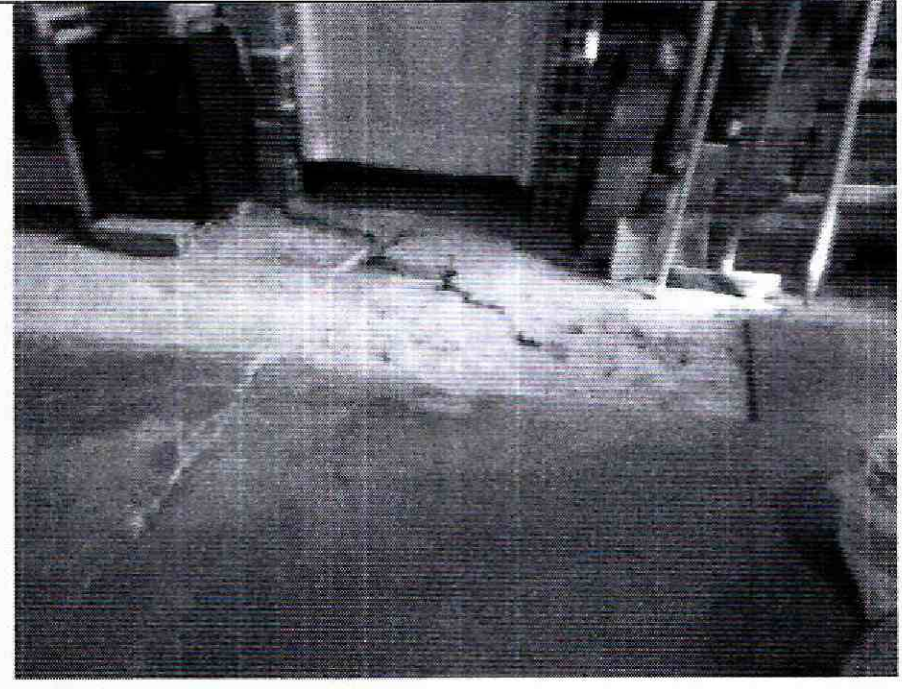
Fisuras en la placa de piso, en la Vivienda evaluada.
